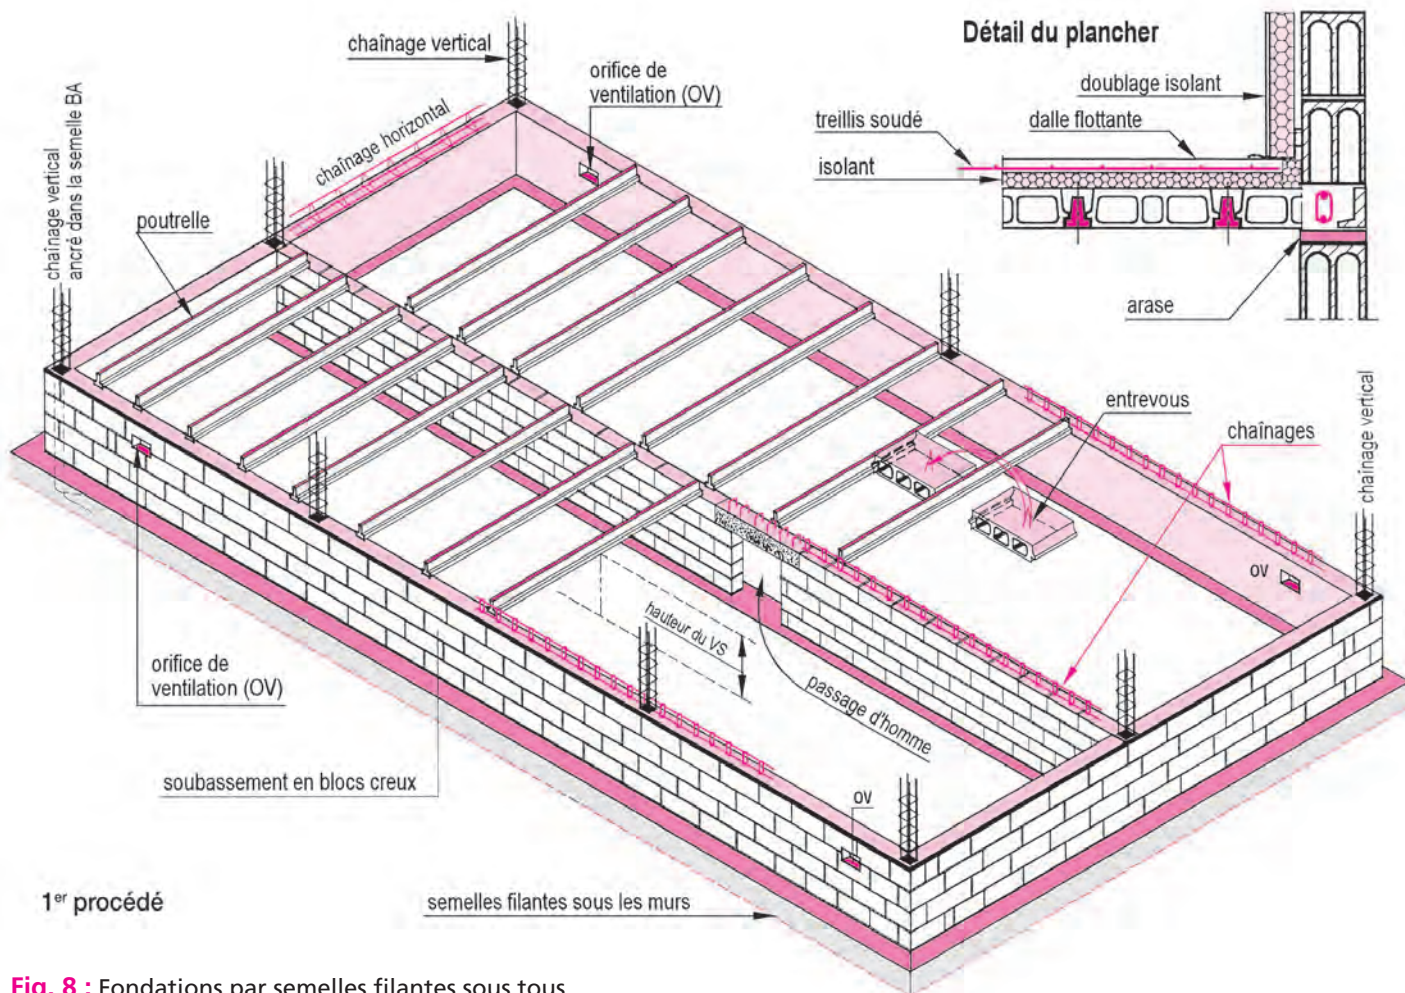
Fondations par semelles filantes sous tous les murs extérieurs et de refend
